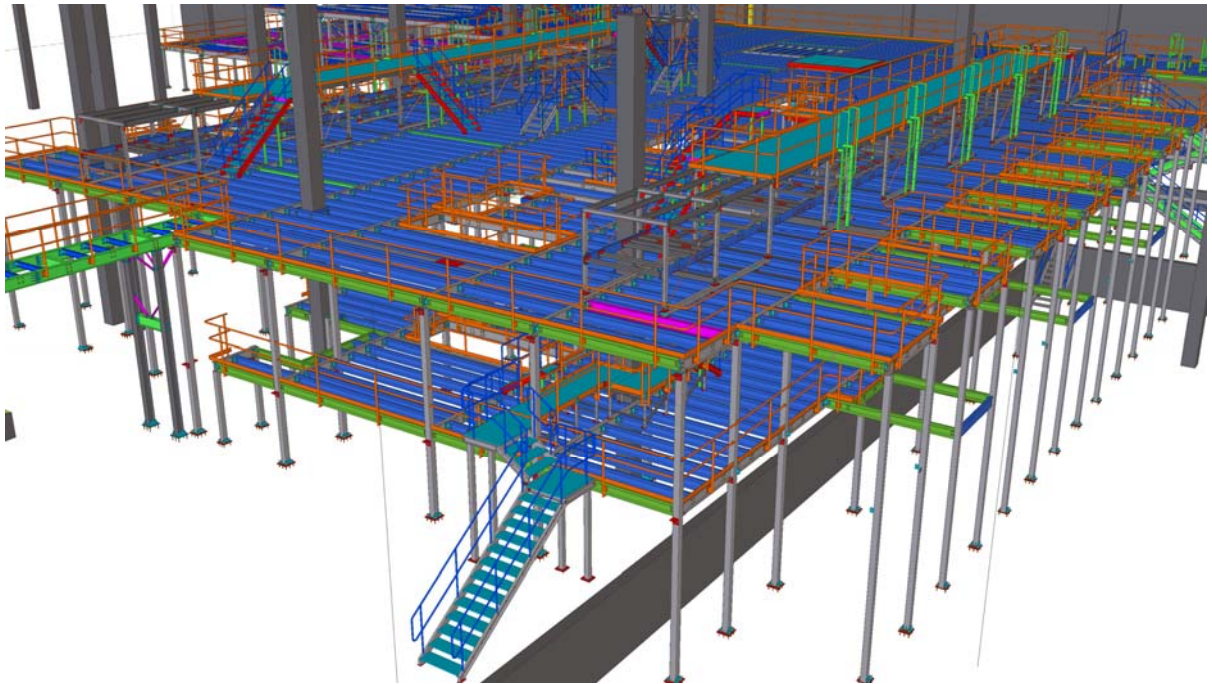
ENTREPLANTA CON DIFERENTES EQUIPAMIENTOS
